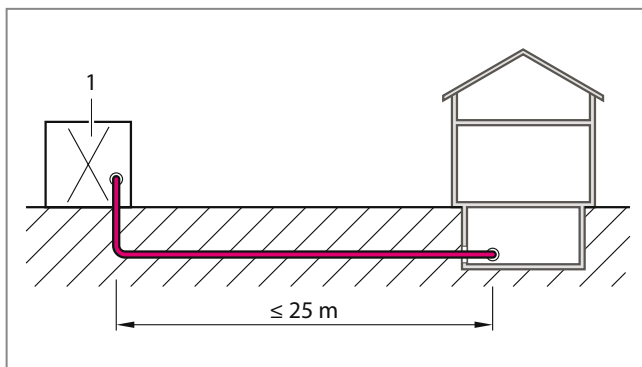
18: Anbindung Wärmepumpe mit einem Hauseinführungsset
